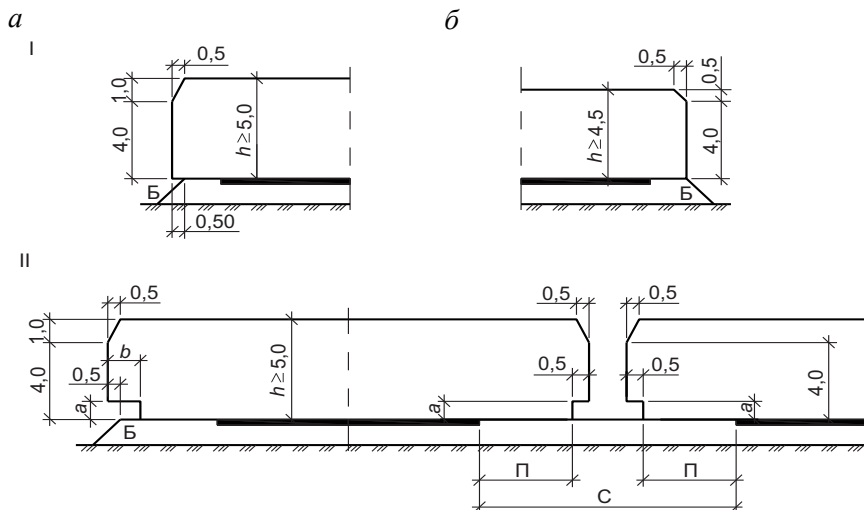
Схемы габаритов приближения конструкций под путепроводами:
